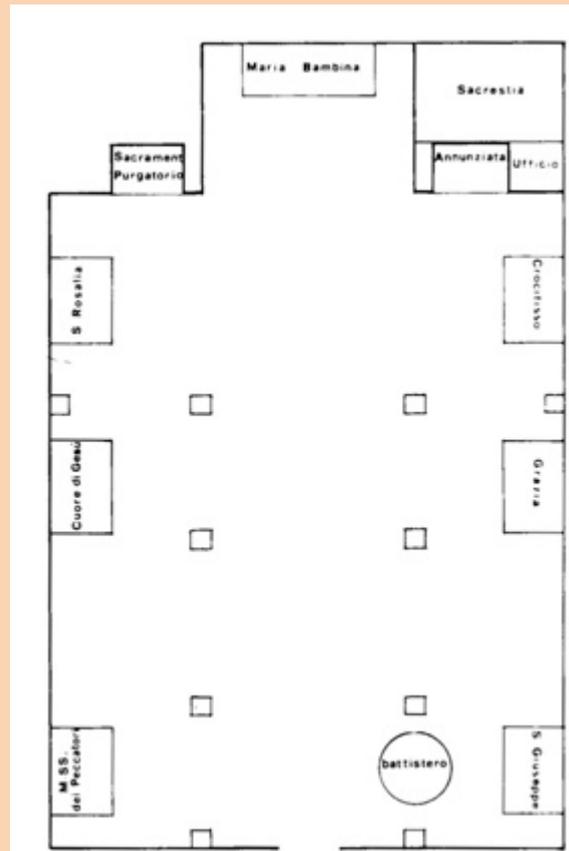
schema planimetrico della chiesa S. Maria di Loreto di Delia nel 1946
